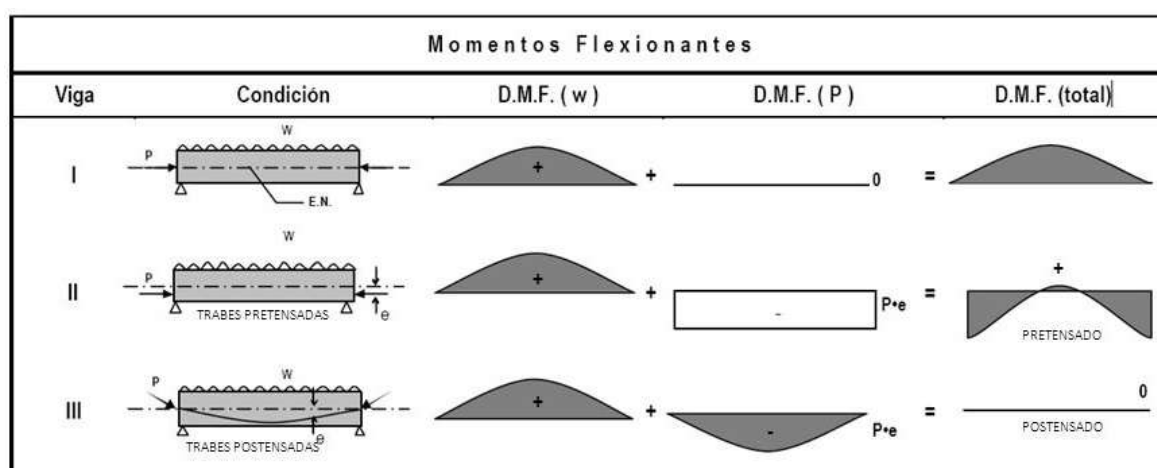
Momentos flexionantes en viguetas pretensadas y postensadas.
